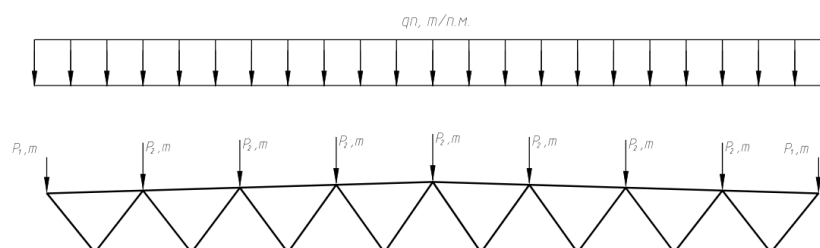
Схема приложения нагрузки от веса покрытия
